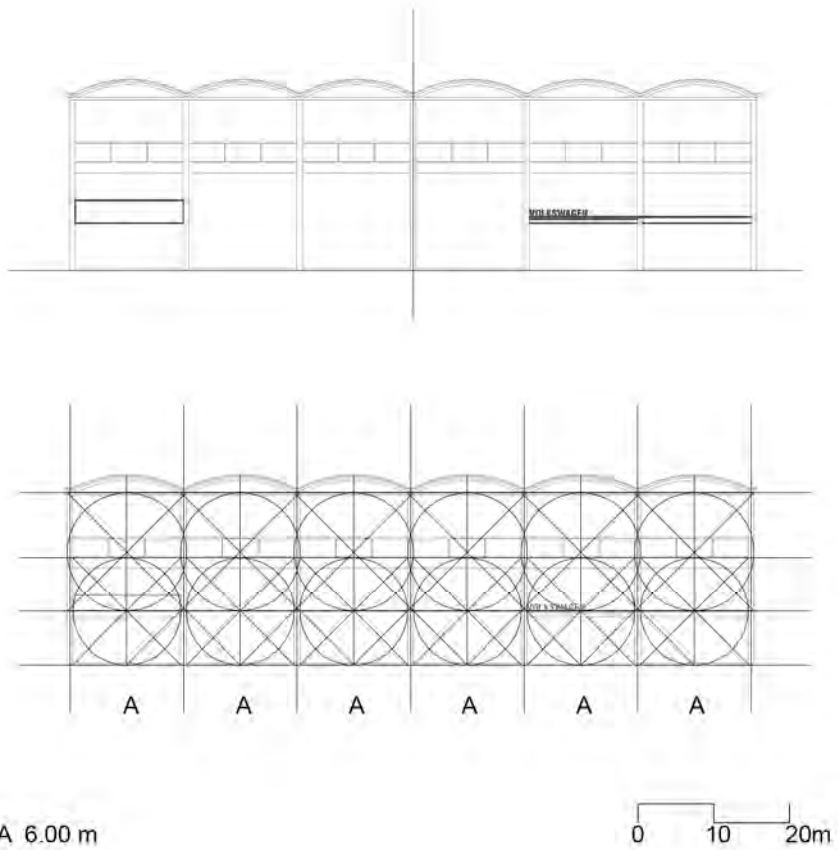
Volkswagen, prospetto sud-ovest. Relazioni di simmetria e variazioni alla regola, geometrie compositive. Fonte: elaborazione dell'autrice.
